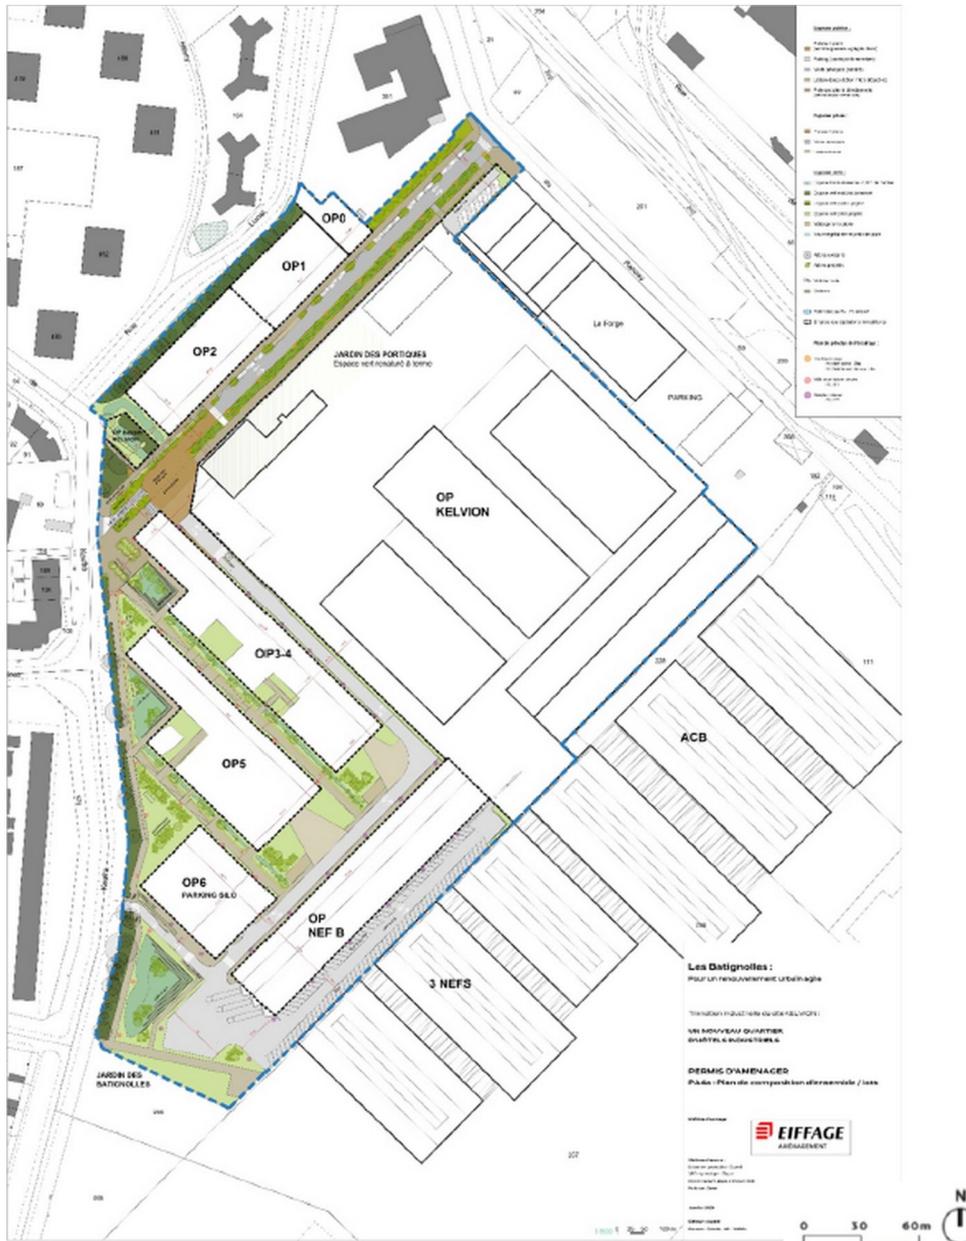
plan masse du secteur Kelvion (source : étude d'impact tome 1 – page 20)
